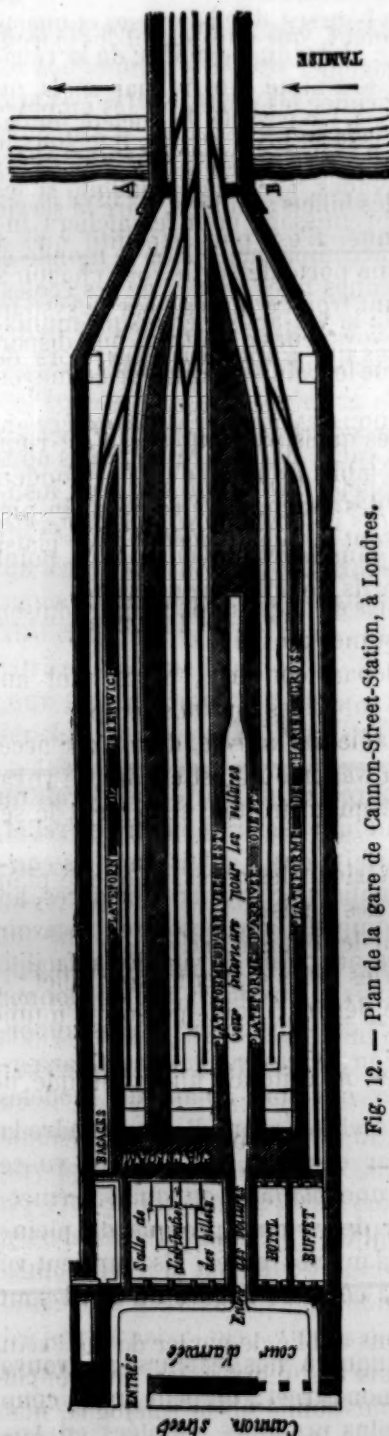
Plan de la gare de Cannon-Street-Station, à Londres.
